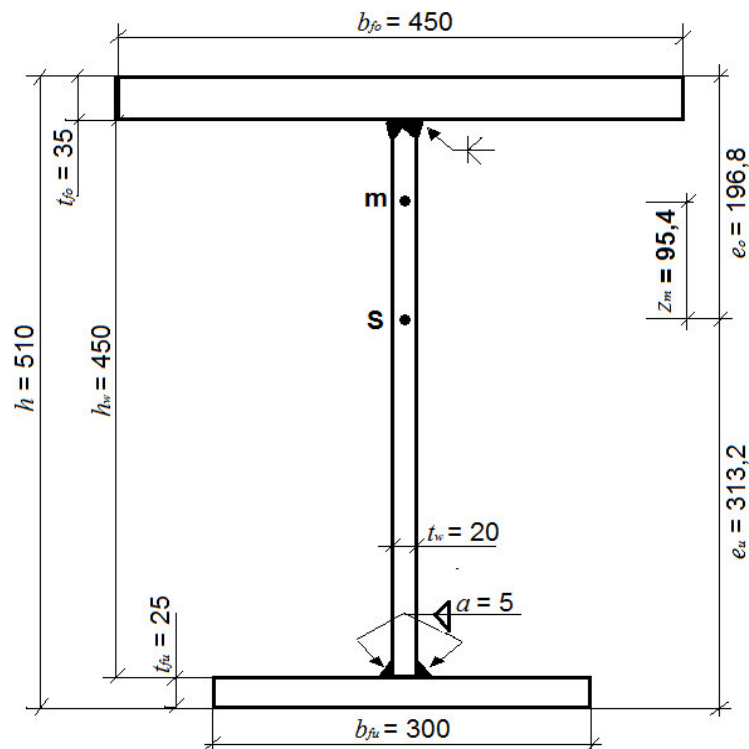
Abmessungen des Schweißprofils [mm], eigene Zeichnung
